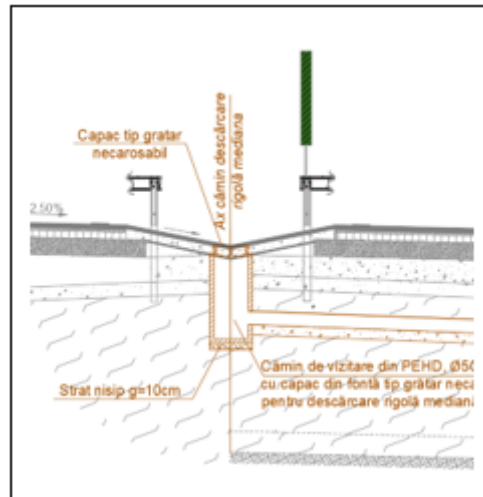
Detaliu zona mediană: secțiunea transversală cu scurgerea apelor
